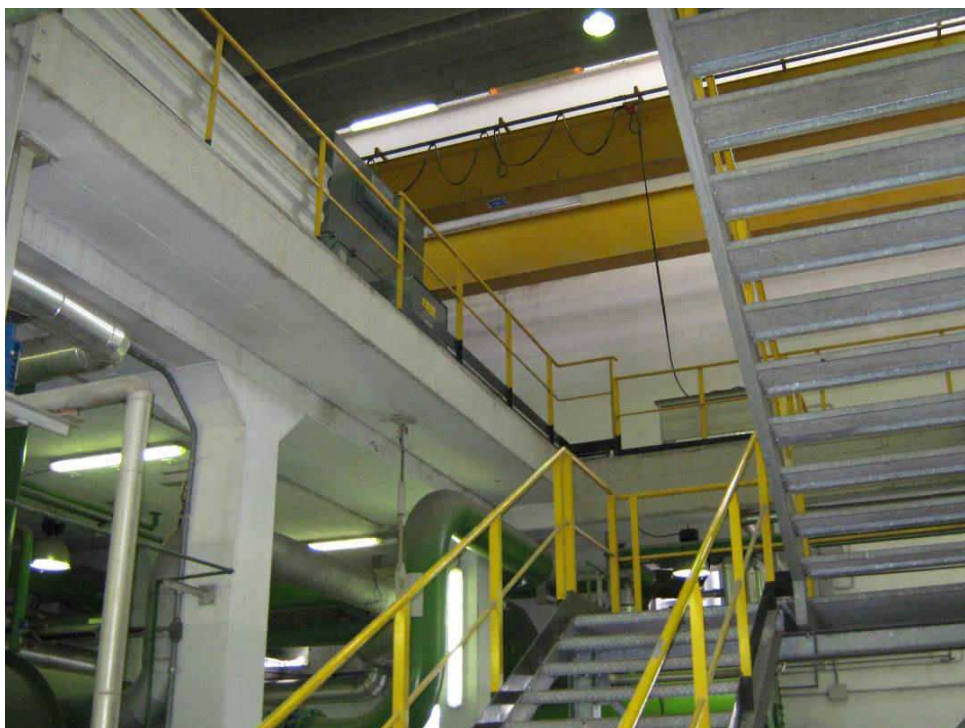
Edificio energia: scale di collegamento tra piano terra e primo, ricavate in corrispondenza delle opere civili di predisposizione per la seconda linea (sede di alloggiamento di turbina e condensatore)
